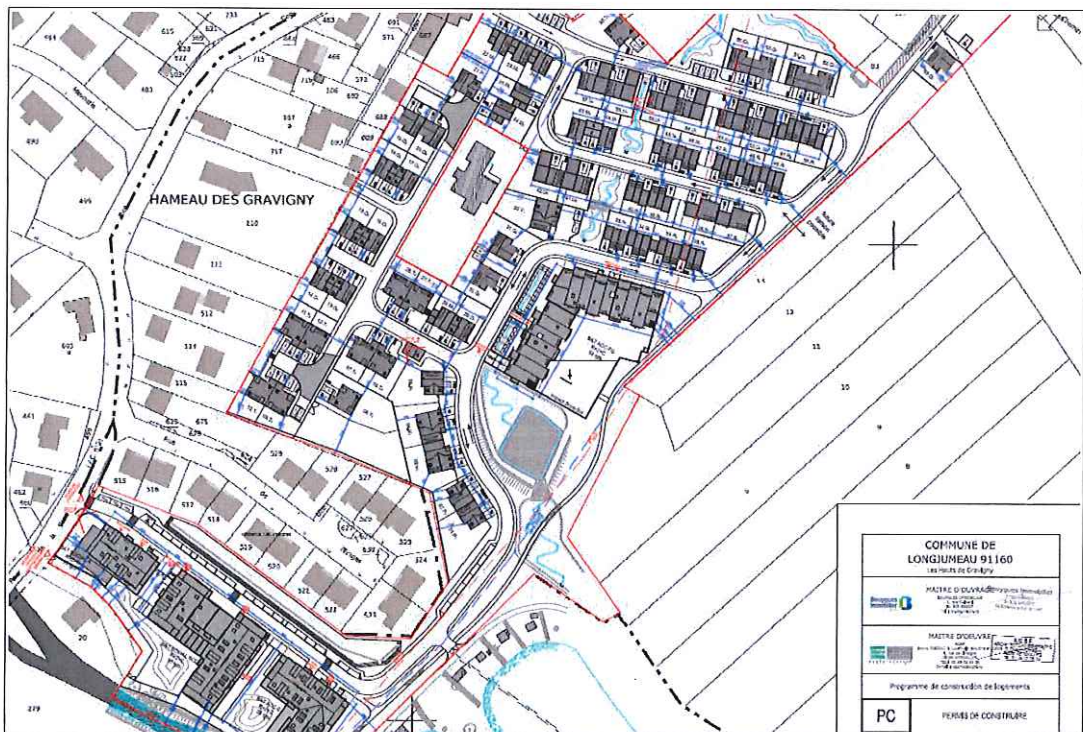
extrait du plan masse des constructions – Source : demande de permis de construire
